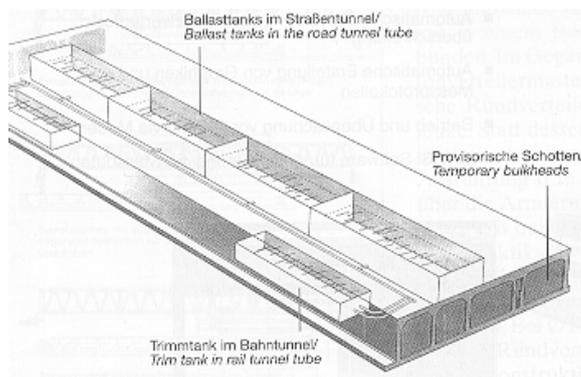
Senkkastenelement mit Ballast- und Trimm tanks
